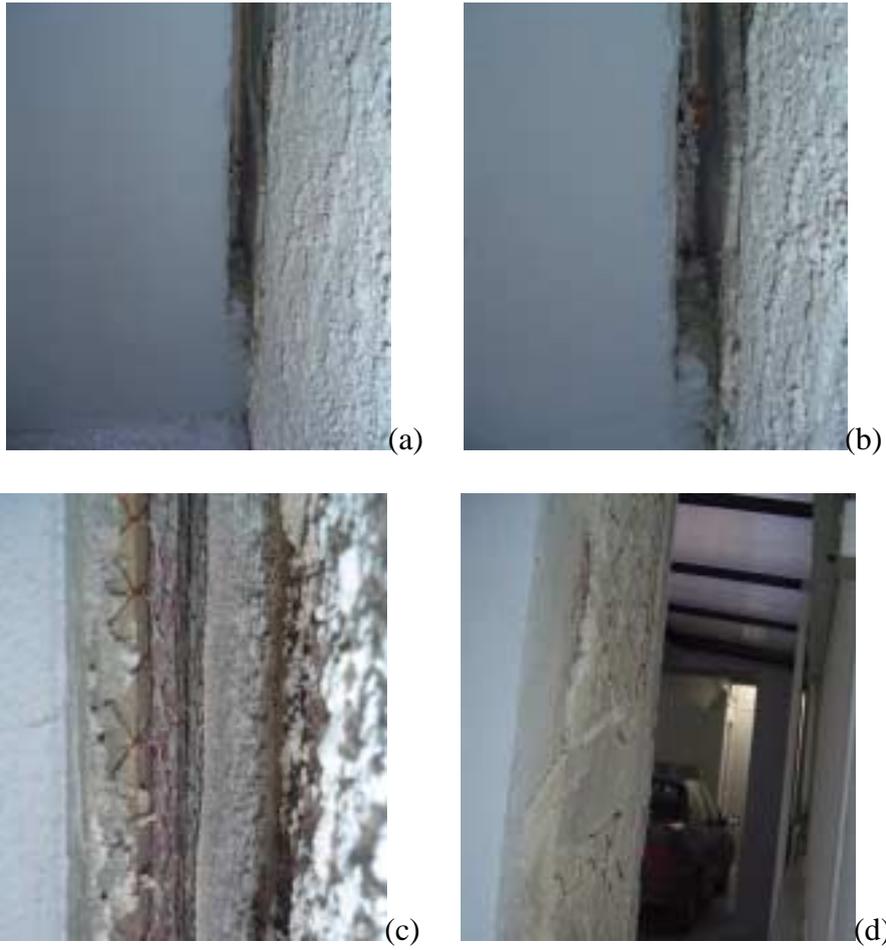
Acabamentos das alvenarias de preenchimento dos pilares nas faces paralelas às divisas
